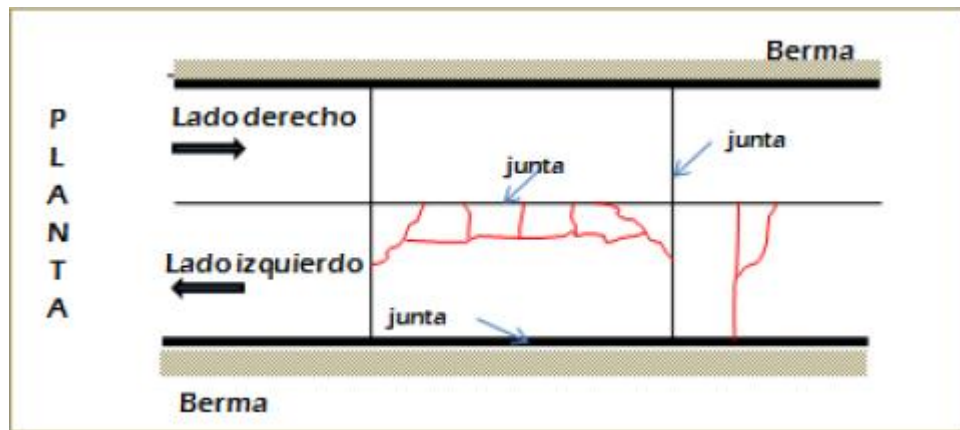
Esquema de la vista en planta de las grietas en bloque.
